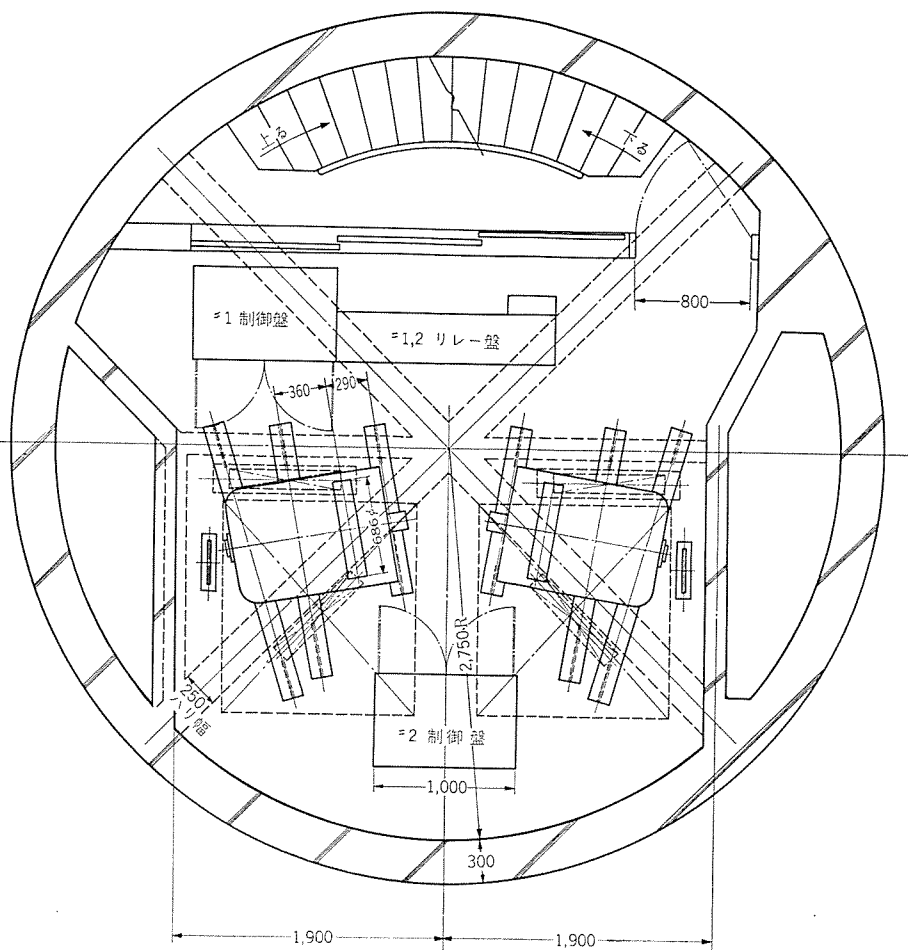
機械平面図 Fig. 3.3 Plan of traction machine room.
